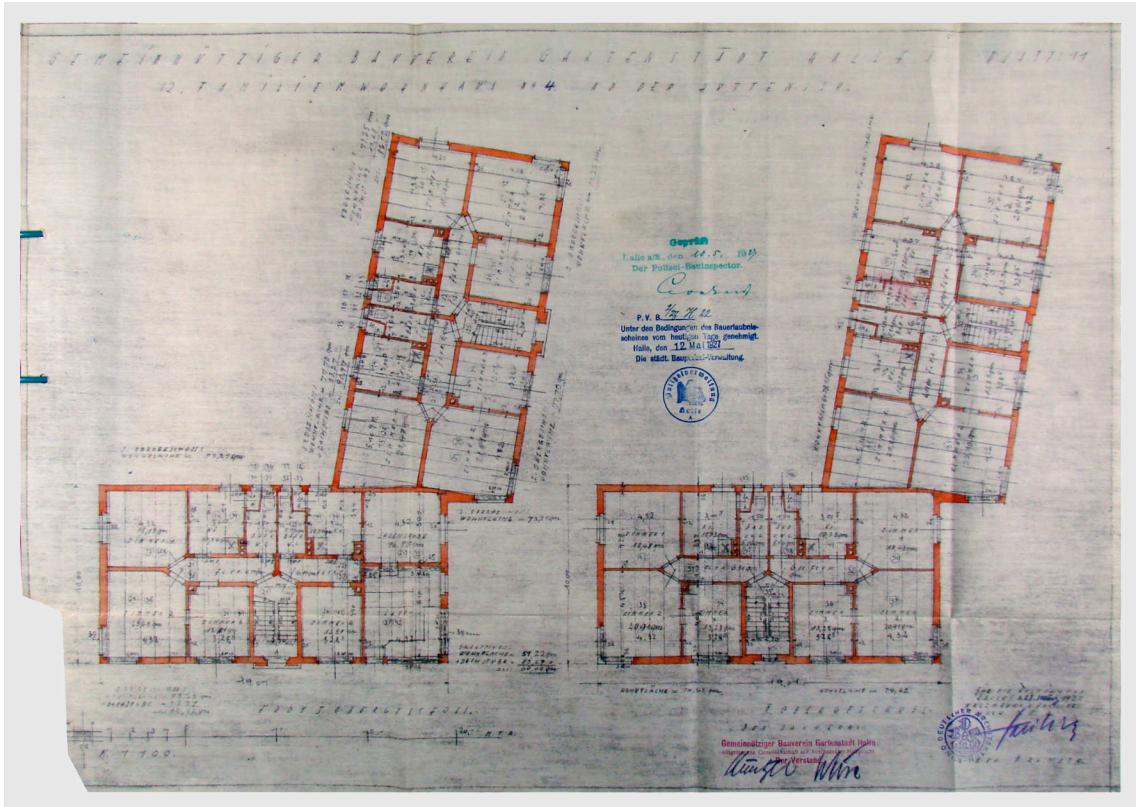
Mehrfamilienwohnhaus im Ammendorfer Weg 1 in Halle, Grundrisse Erd- und zweites Obergeschoss, datiert 23. März 1927.
